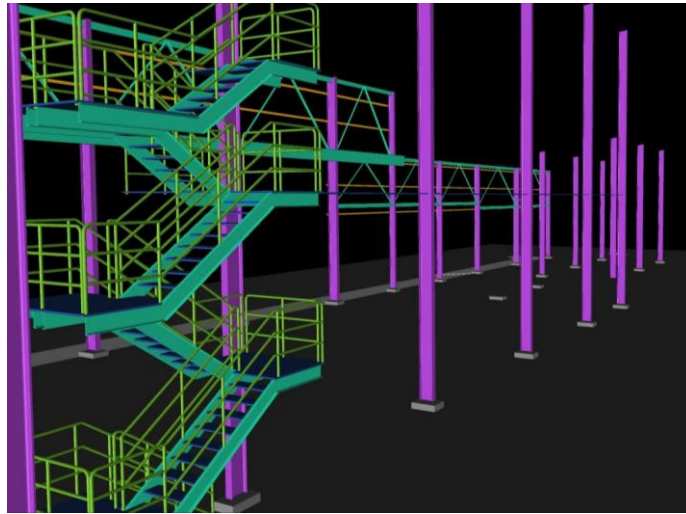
Montaje de la torre estructural para acceso peatonal en eje D1-D
